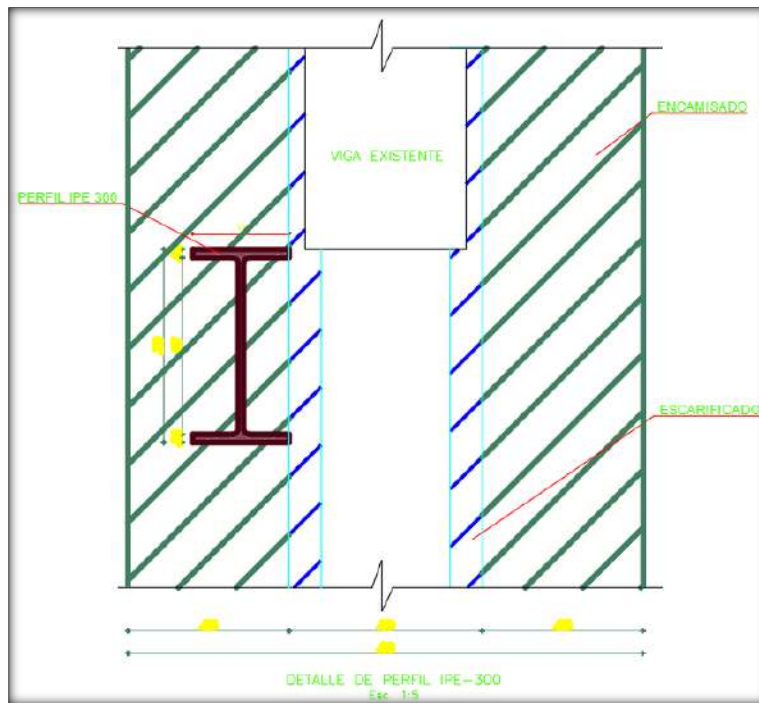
Esquema representativo del perfil metálico reforzando vigas y columnas de concreto.
